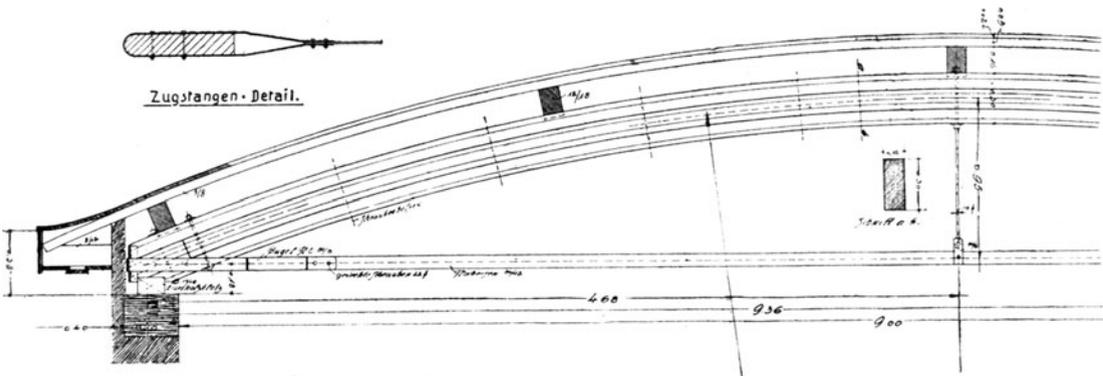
Vollwandbinder mit schlaufenförmigen, um das Auflager herum geführten eisernen Zugstangen.
